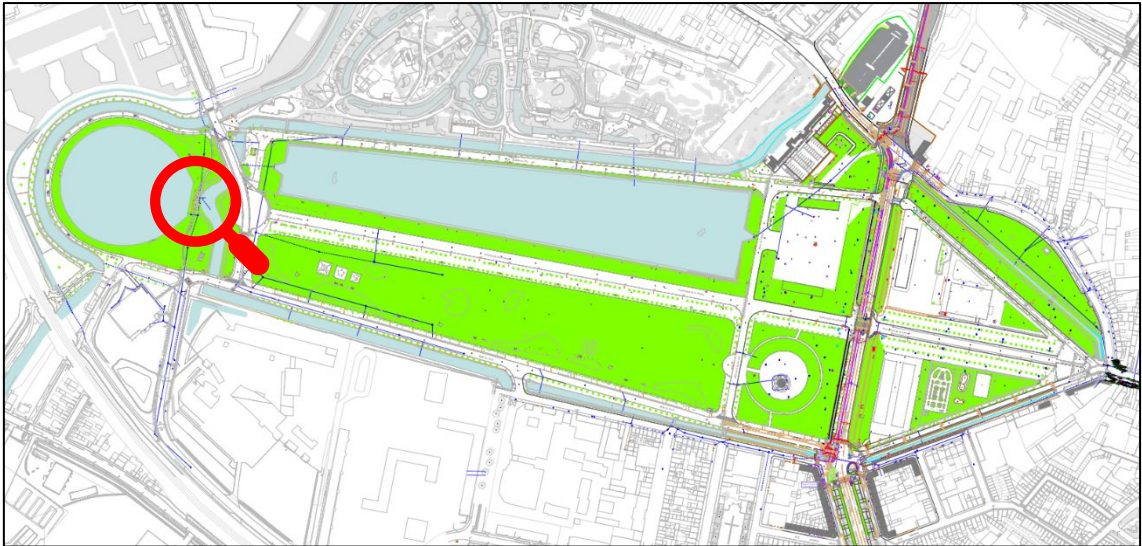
Extrait de plan du réseau pluvial - secteur ouest
